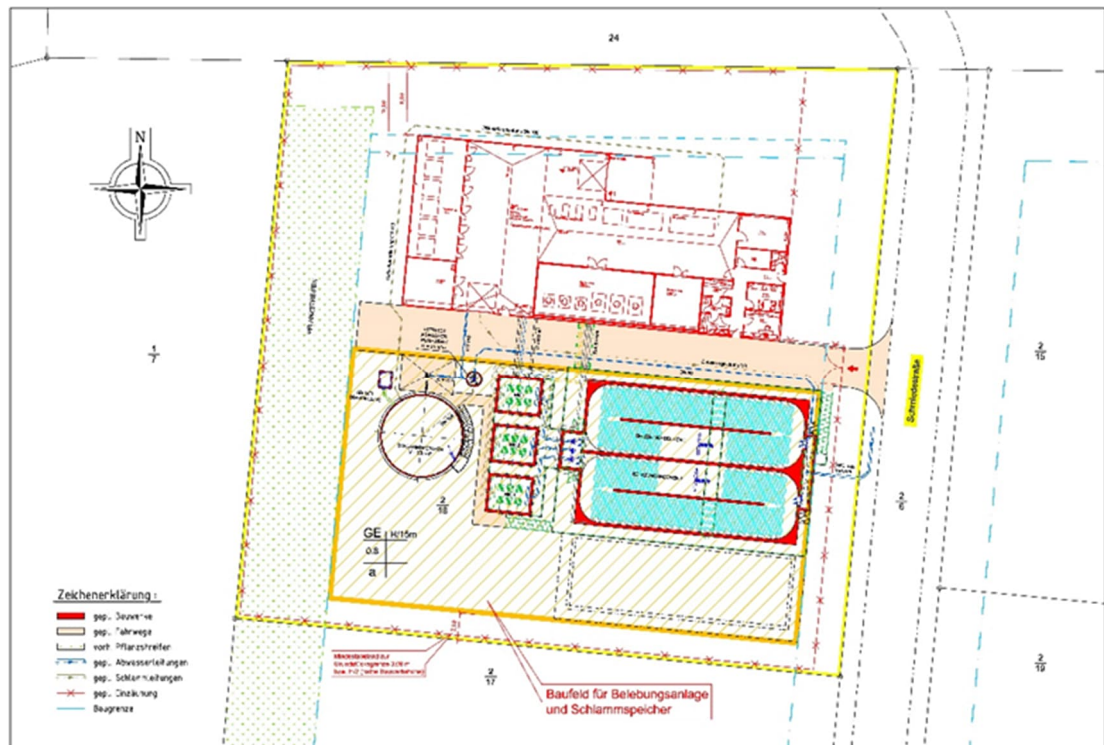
Auszug aus Lageplan mit geplanten Bauwerken
